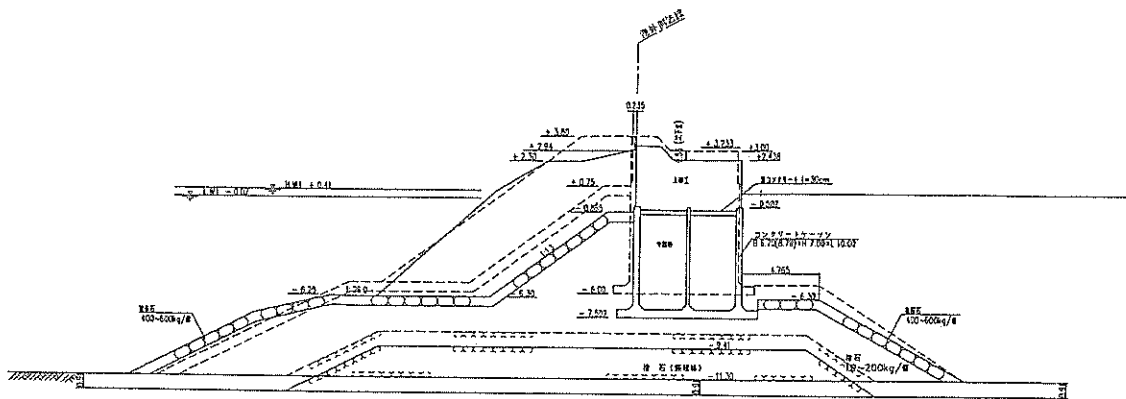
防波堤（波除）⑨ 標準断面図・被災変形図
